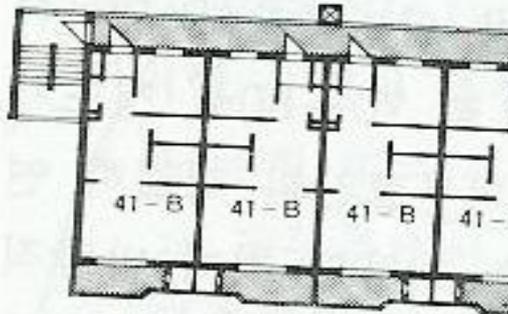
Y자형 블록 플랜 (block plan) 평면에
